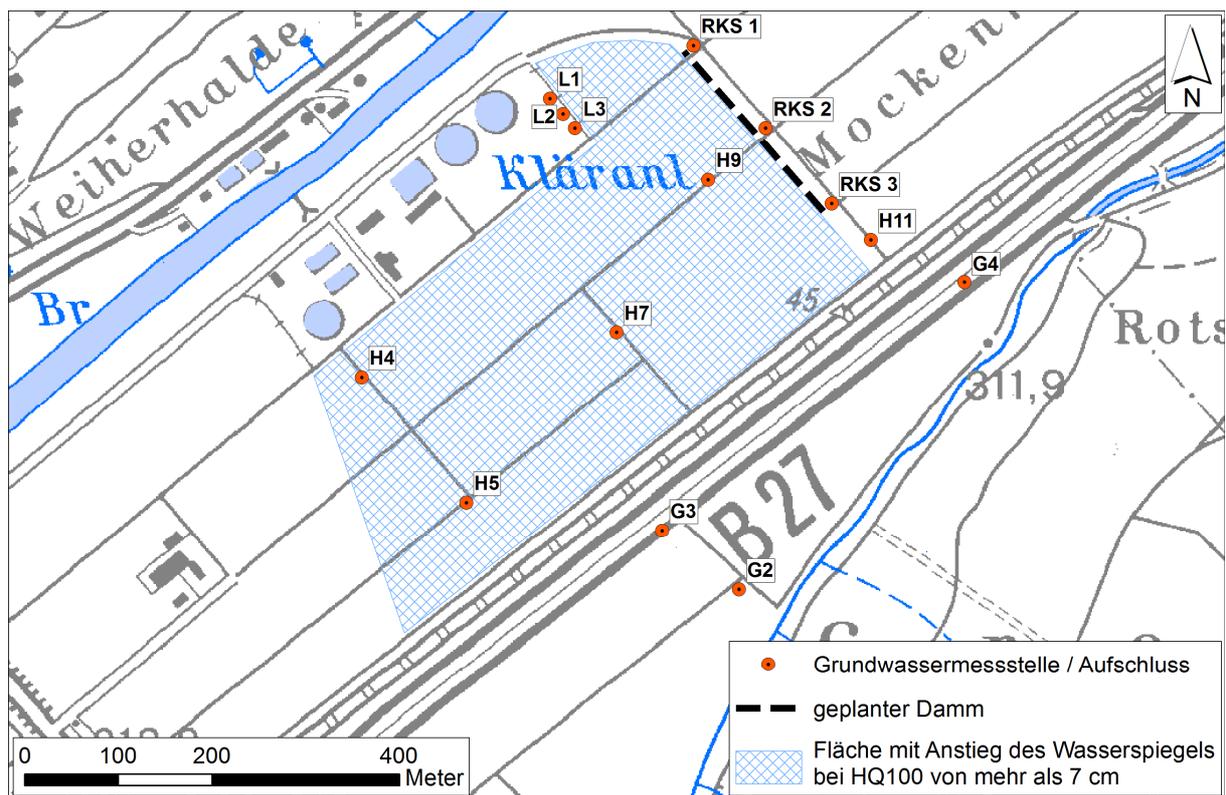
Lageplan mit Grundwassermessstellen und Aufschlüssen im Umfeld des geplanten Retentionsraums
